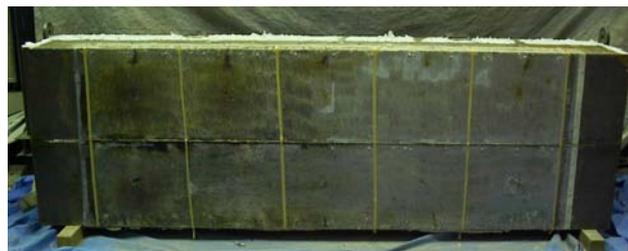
耐火被覆撤去後のコンクリート充填鋼殻試験体(CFSS1)加熱面状況
